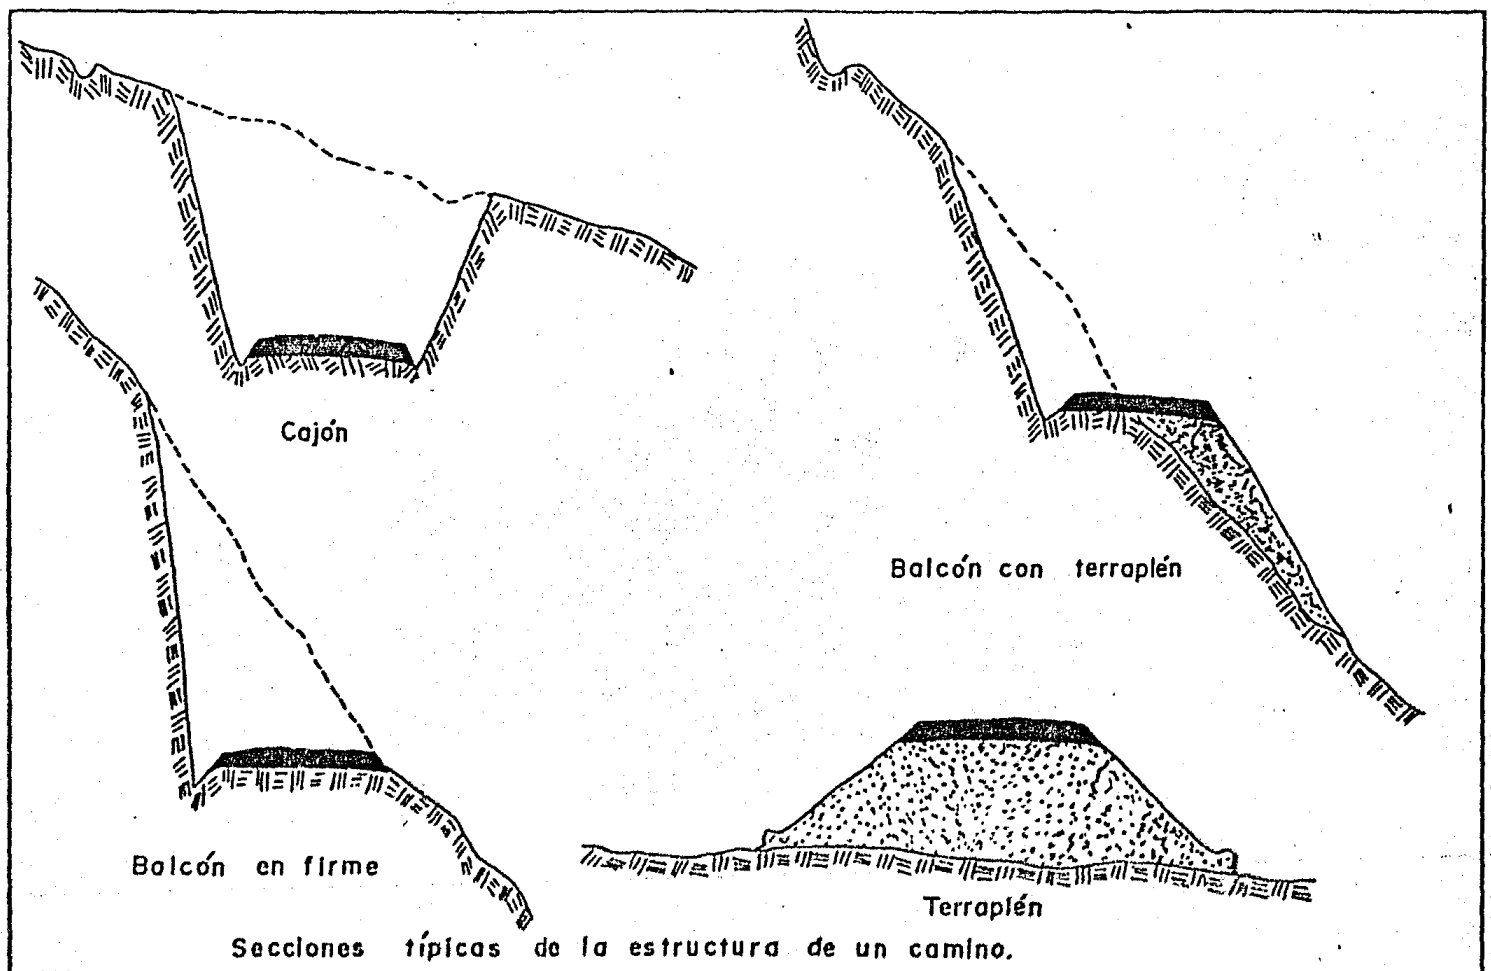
Secciones Transversales Típicas de Carreteras.
